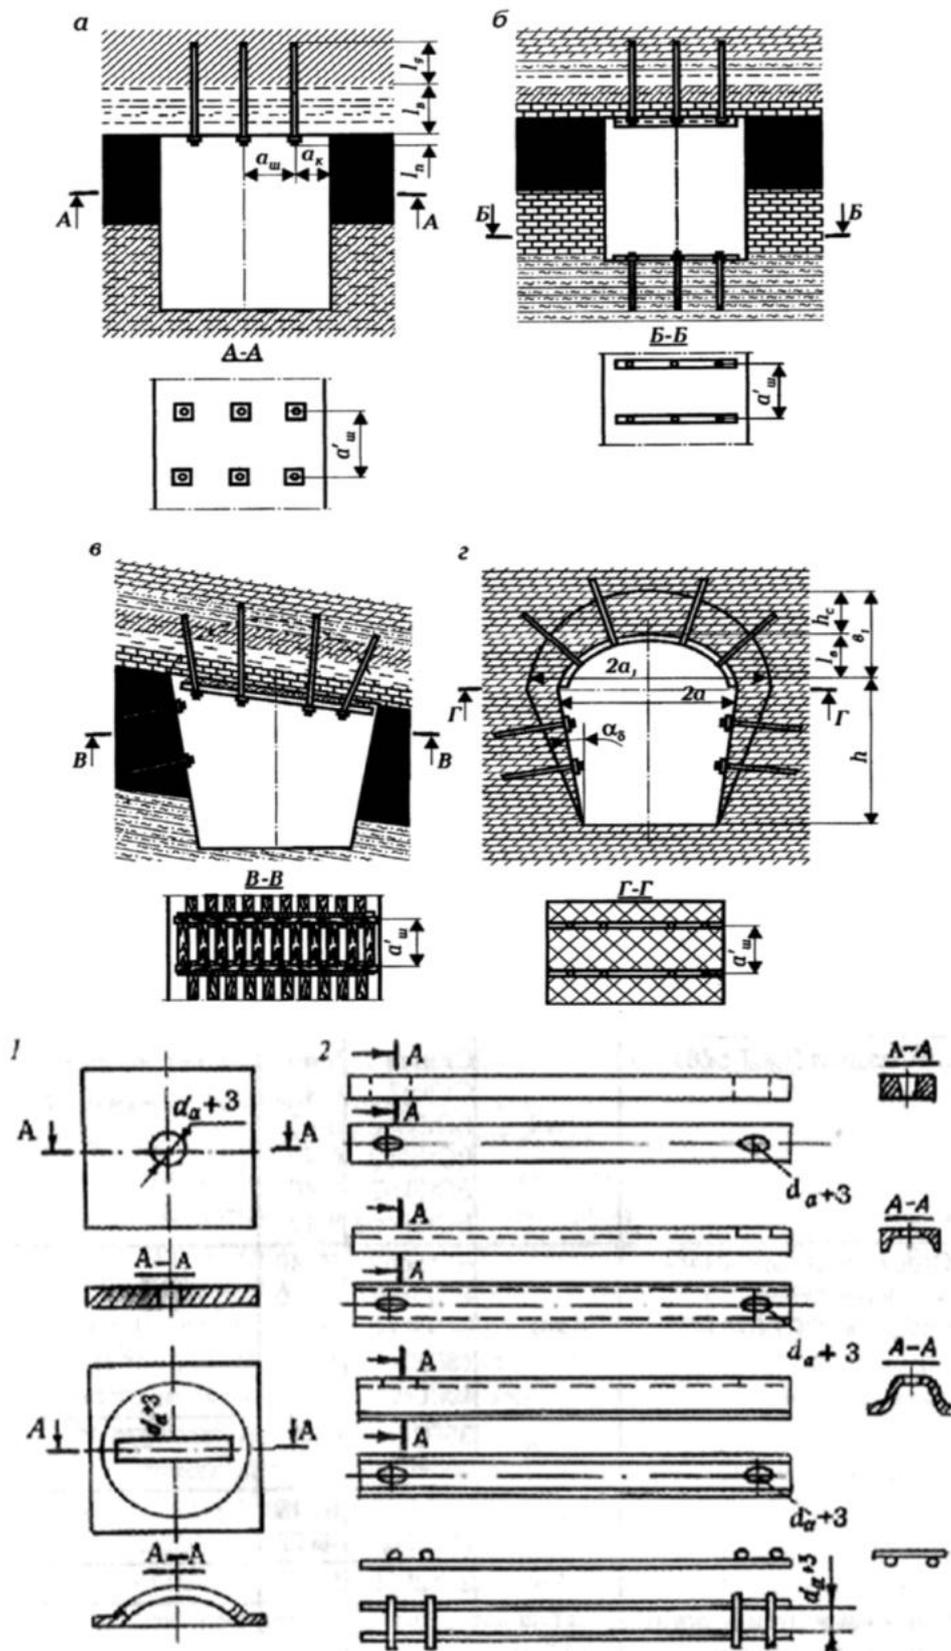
Схемы крепления выработок анкерами: а - штанги с опорными плитками в кровле; б - штанги с металлическими подхватами в кровле и подошве; в - штанги с деревянными подхватами в кровле и с опорными плитками в боках; г - штанги с металлическим арочным подхватом и с затяжкой из сетки. 1 - опорные плитки; 2 - металлические подхваты
